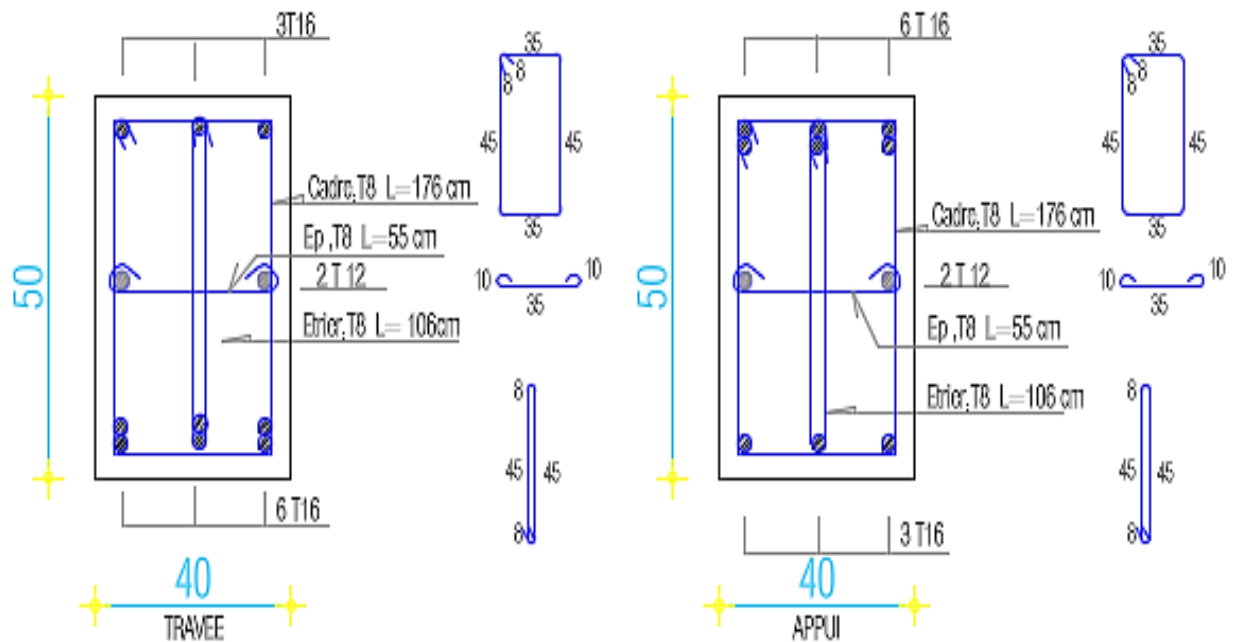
Schéma de ferraillage de la poutre de chaînage sur travée et appuis.
